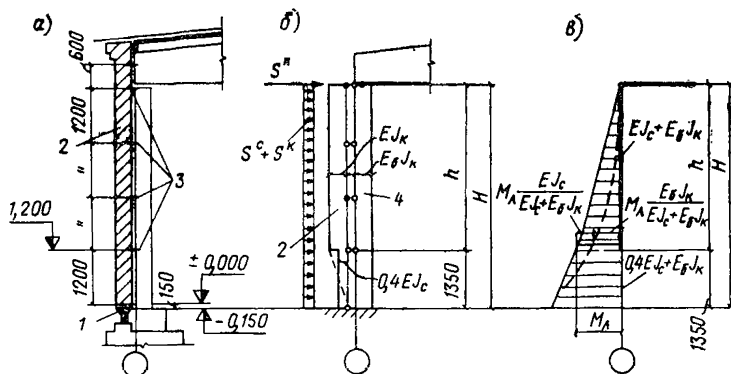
Схемы к расчету каркаса здания с учетом жесткости самонесущих стен
